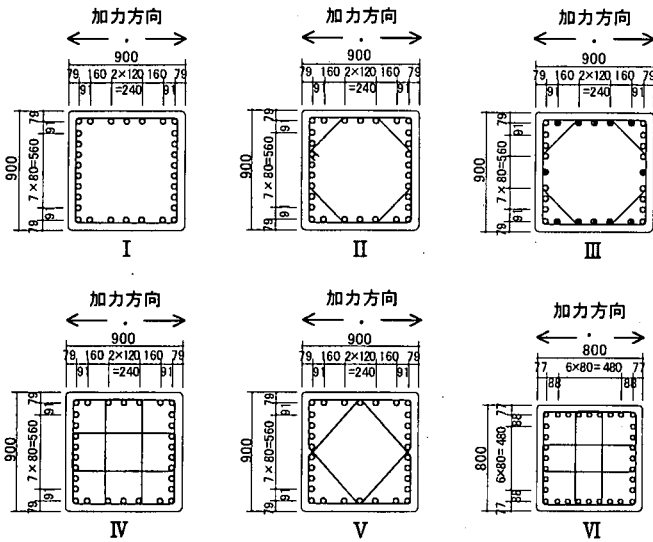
供試体断面 (単位: mm) ○: D32 ●: D29
